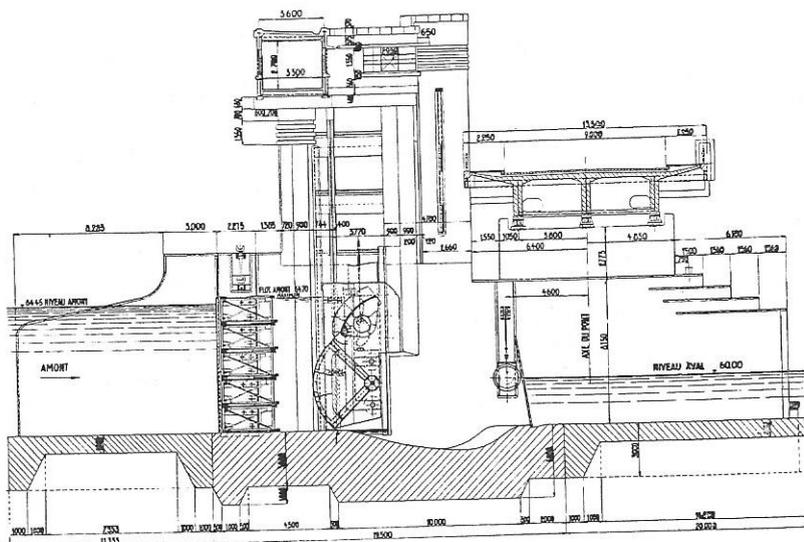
Coupe axiale d'un pertuis faisant bien apparaître les dispositions des vanne principale, hausse, pont-route, passerelle de service et bouchures de secours.
